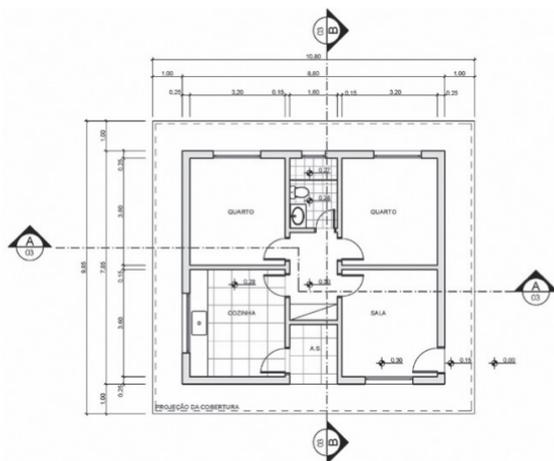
| Projeção do plano secante no eixo transversal da edificação
